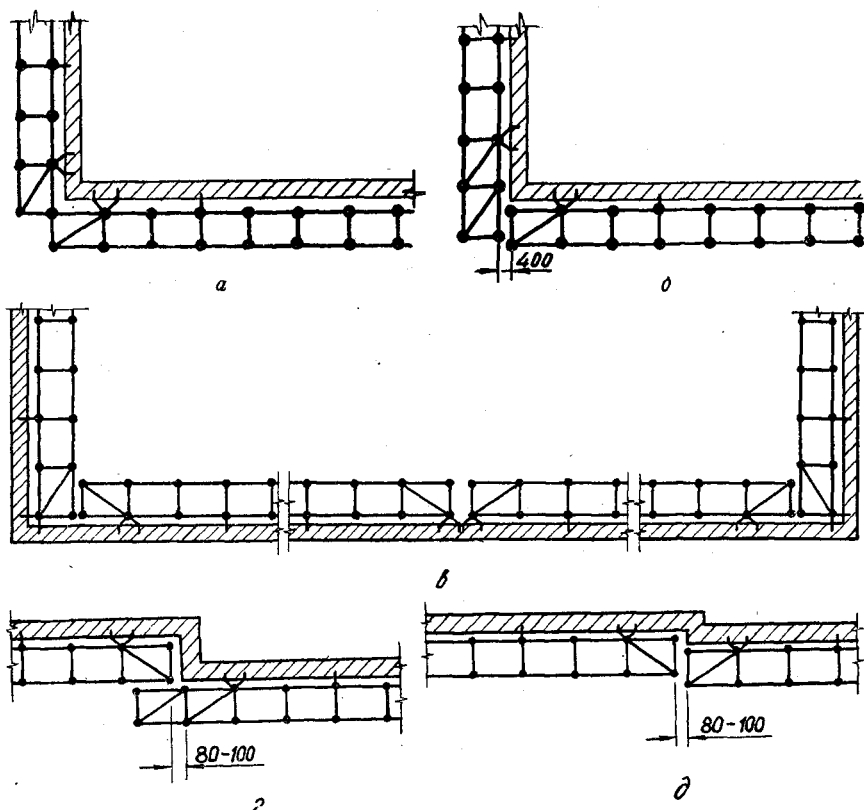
Варианты установки лесов по углам здания и у выступов вдоль стен:
